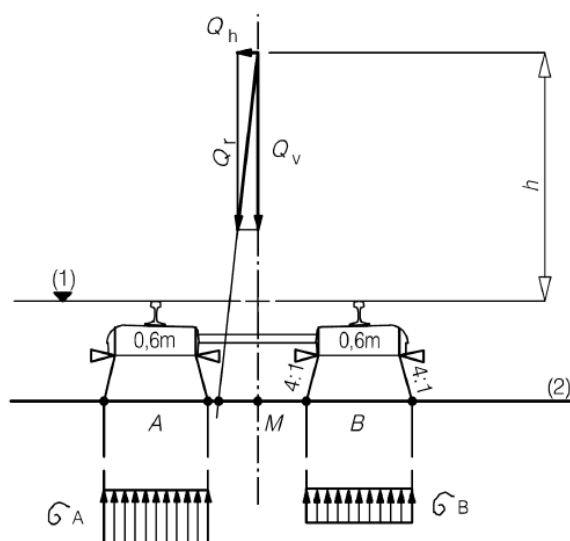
Distribuição transversal da carga pela travessa e pelo balastro num troço de via sem sobreelevação.
